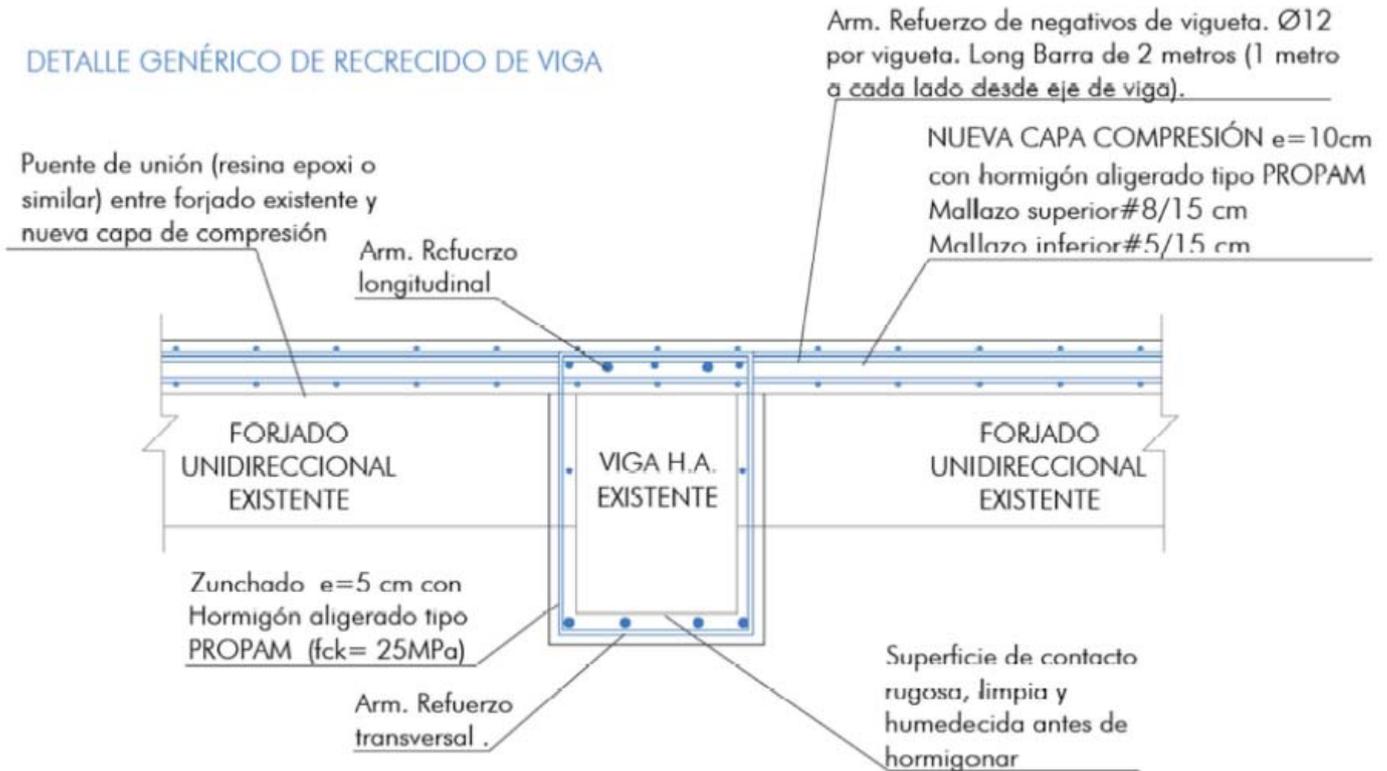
Detalle genérico de refuerzo en cajón de viga tipo.
